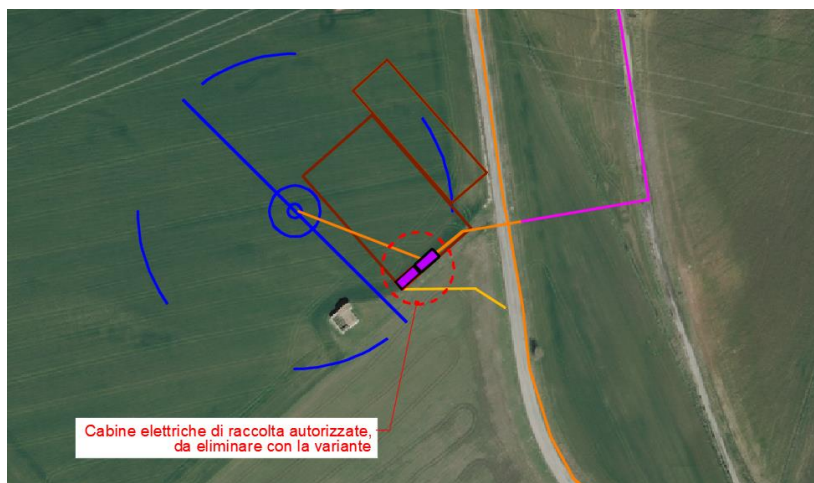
Stralcio su ortofoto con evidenza delle cabine di raccolta da eliminare con la variante
